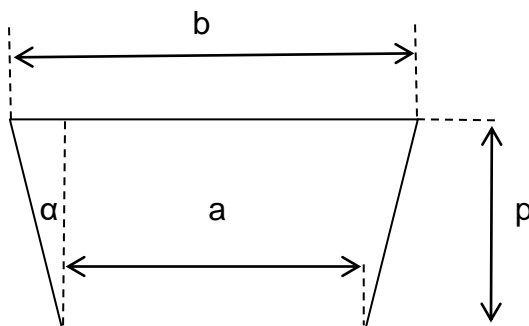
Principales variables de sección transversal de zanja trapezoidal.
